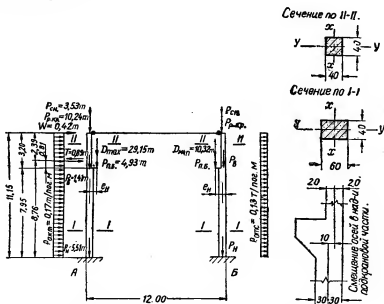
Расчетная схема поперечника и схема нагрузок.
